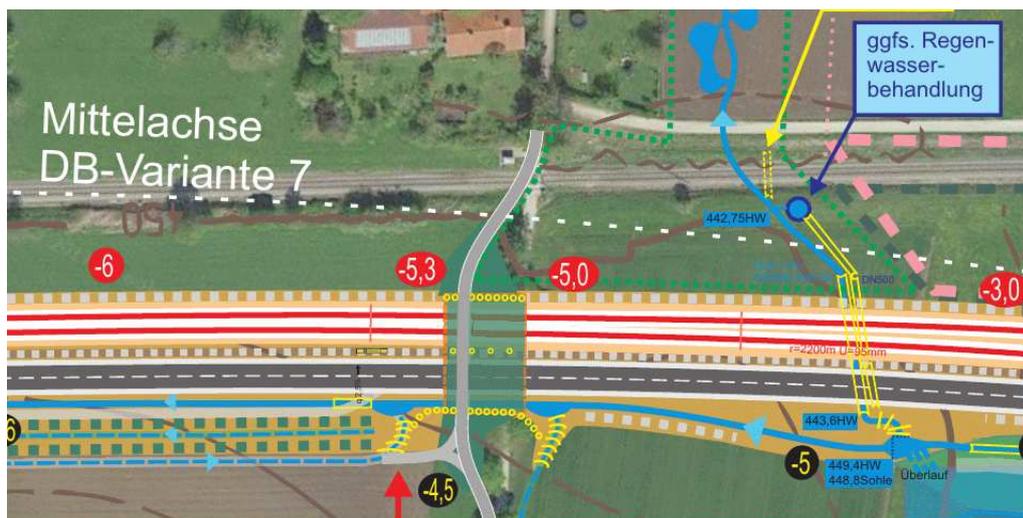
Fuß- und Radwegüberführung Birkenallee über den Einschnitt mit Eisenbahn, Staatsstraße und Hochwasser-Umleitung
